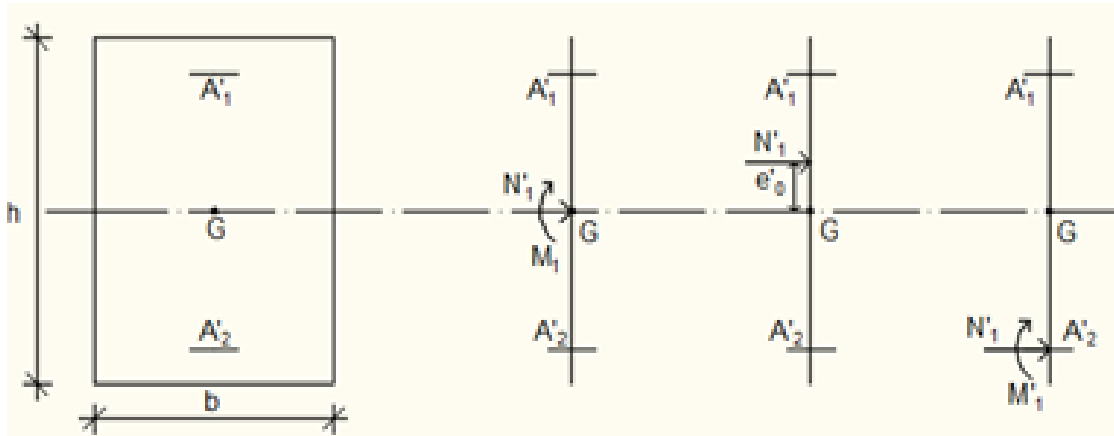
Position de N'_1 M'_1 et M_1 sur la section transversale.
